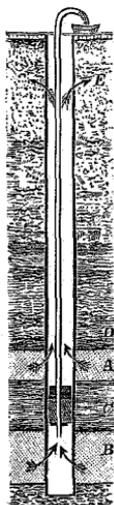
Coupe d'un puits montrant un essai imparfait.
